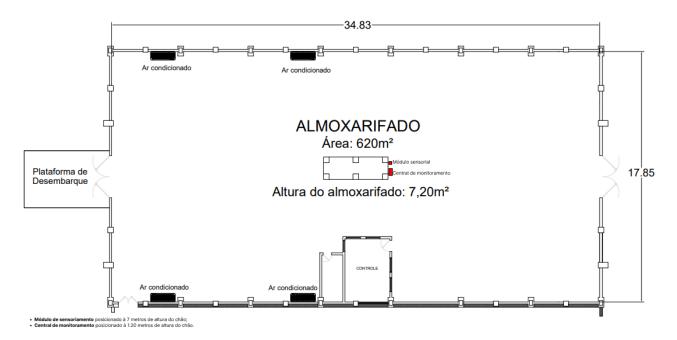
Planta de demonstração do espaço já com o dispositivo implantado
